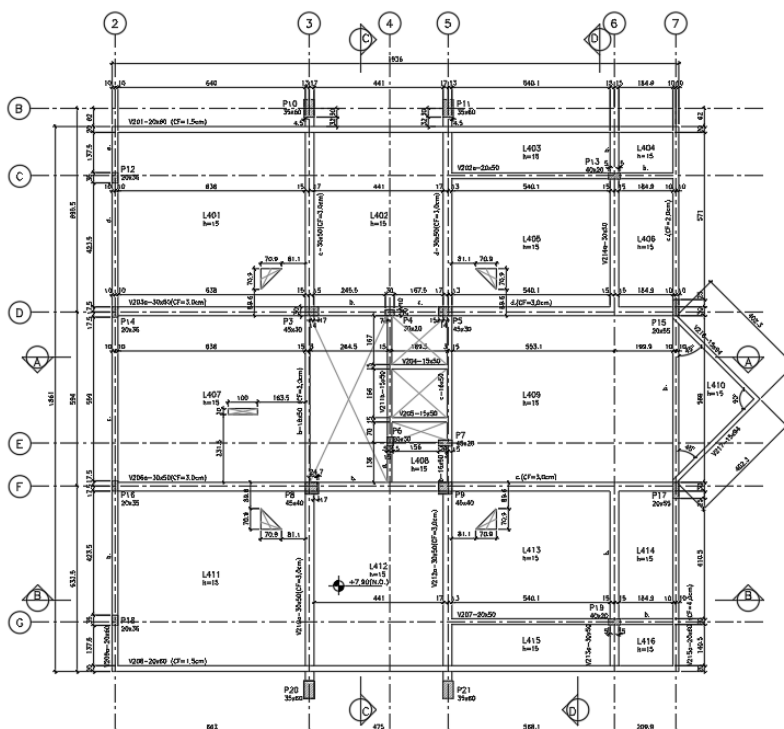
Plantas dos pavimentos do teto do térreo, primeiro e telhado. Os pavimentos são bem semelhantes, com pequenas variações na geometria [desenho código 04-DPSC-PE-EST-PB-04-R01].
